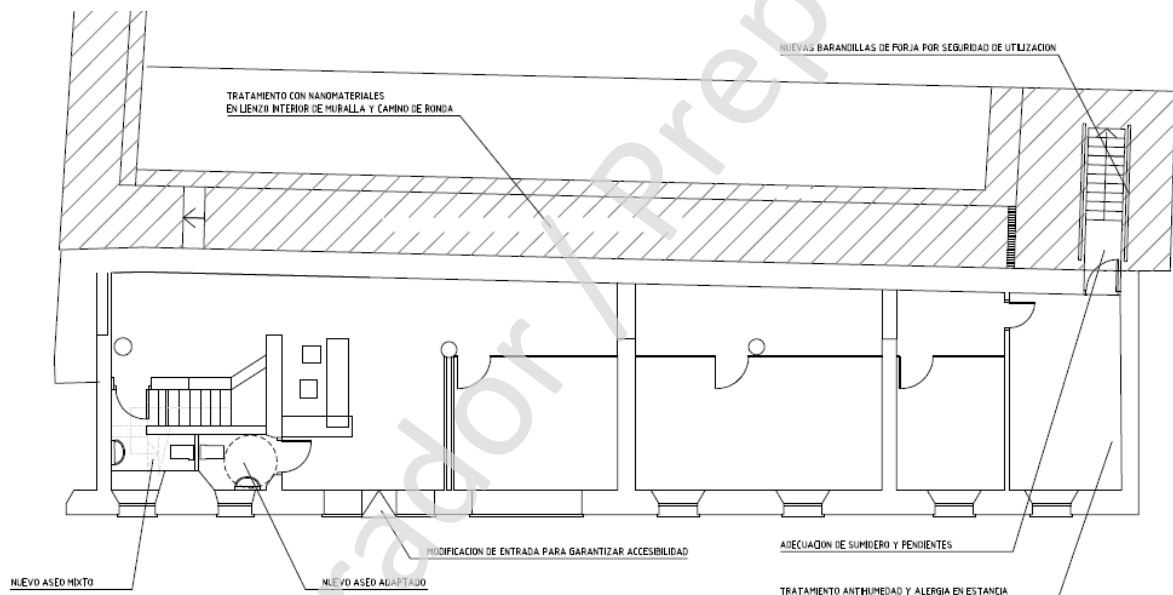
Propuesta de actuación en planta baja del Servicio de Fiestas Mayores según se recoge en el Proyecto de Obras
